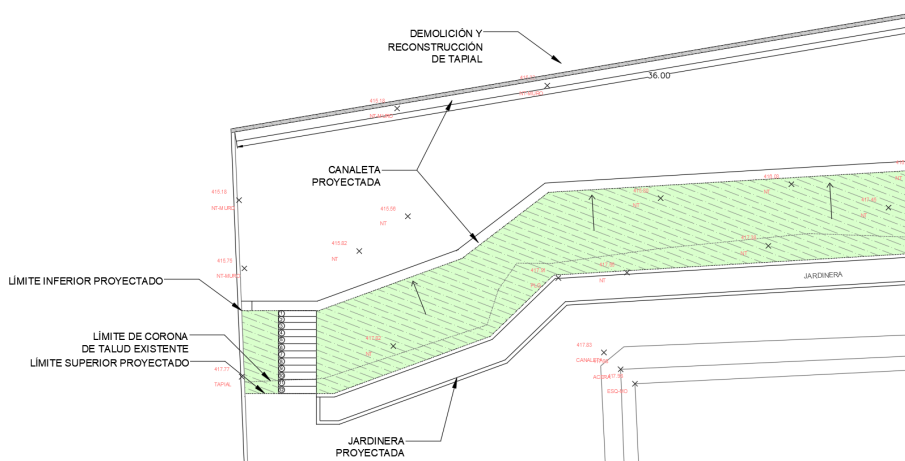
19. Vista en planta de propuesta en talud interior.
